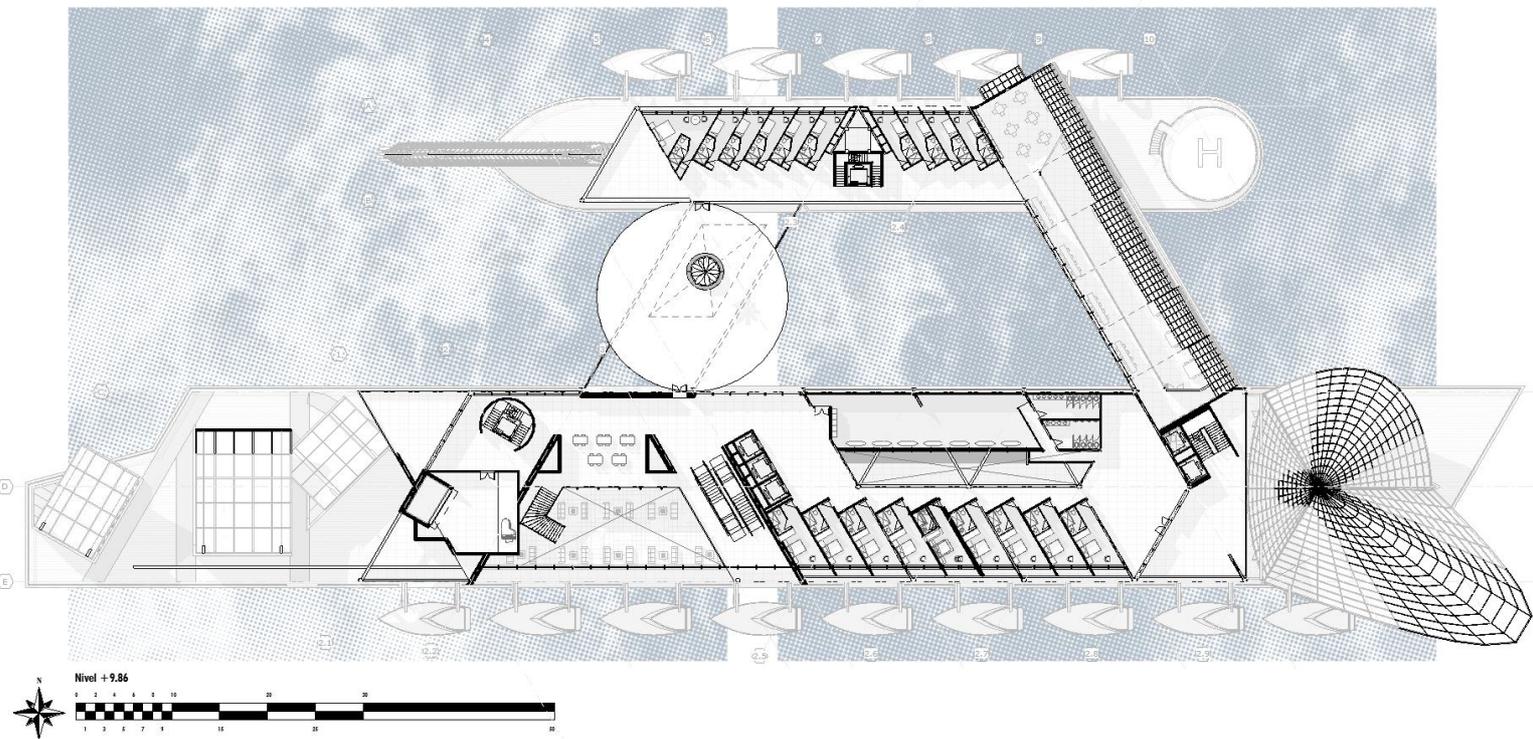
Planta nivel +9.86 - Elaboración Propia
